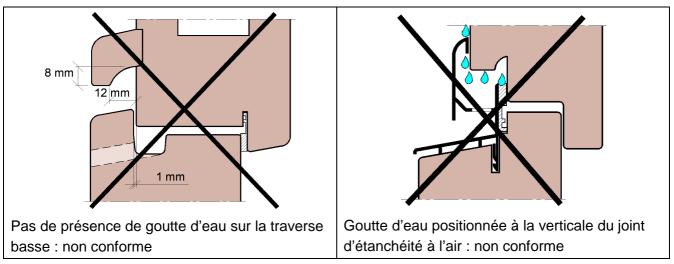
Exemples de dispositif d'arrêt d'eau non conforme
